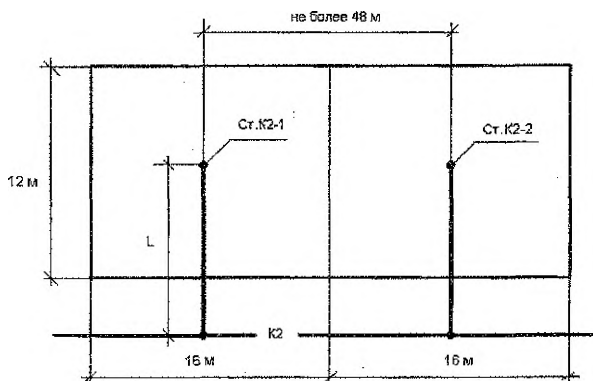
План кровли с размещением внутренних водостоков
